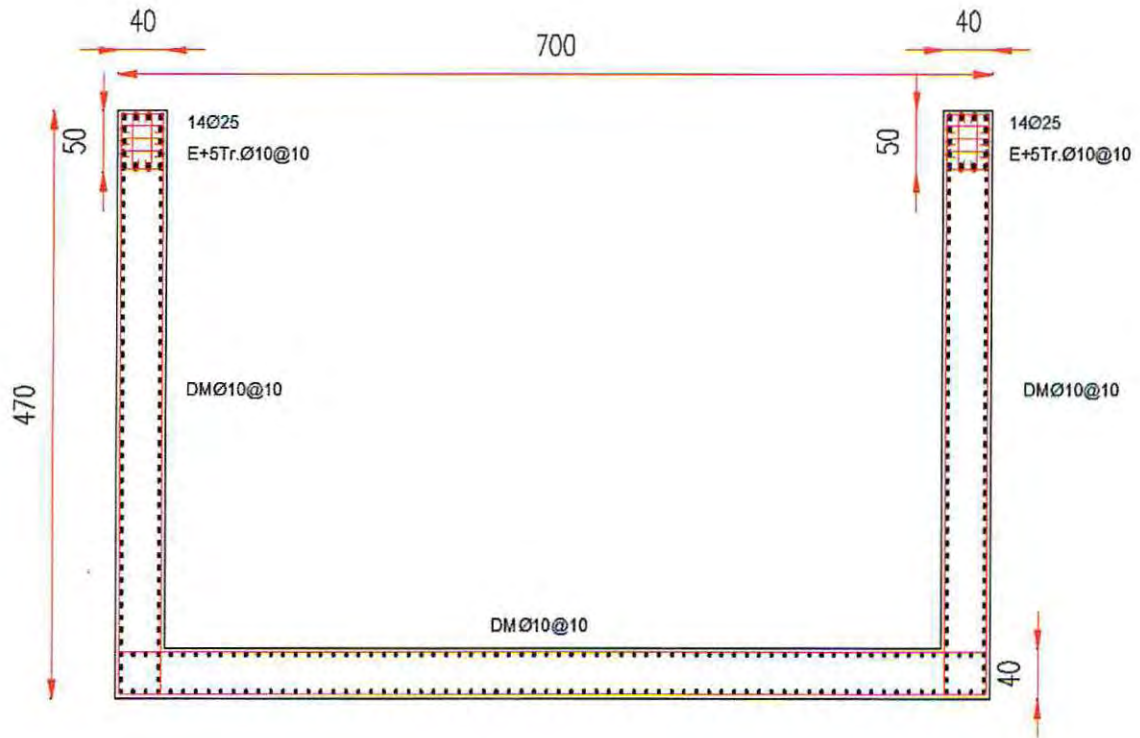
Disposición armadura Ed. Tradicional muro "C".
